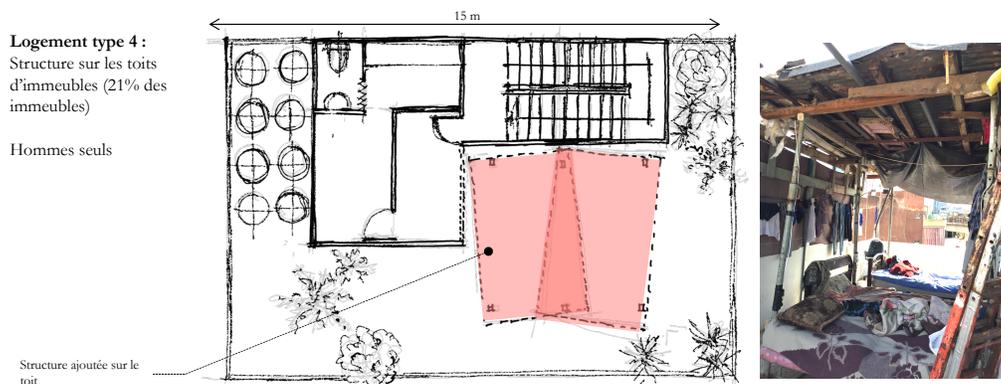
Logement de type 4 – Structures sur les toits (Kikano, 2020)
